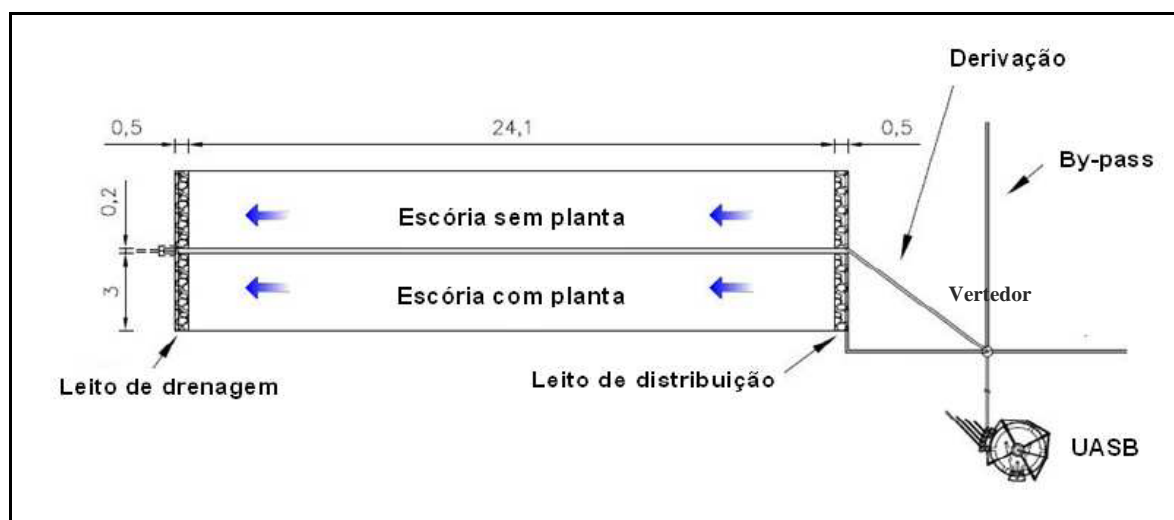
Planta dos sistemas de wetlands horizontais subsuperficiais
